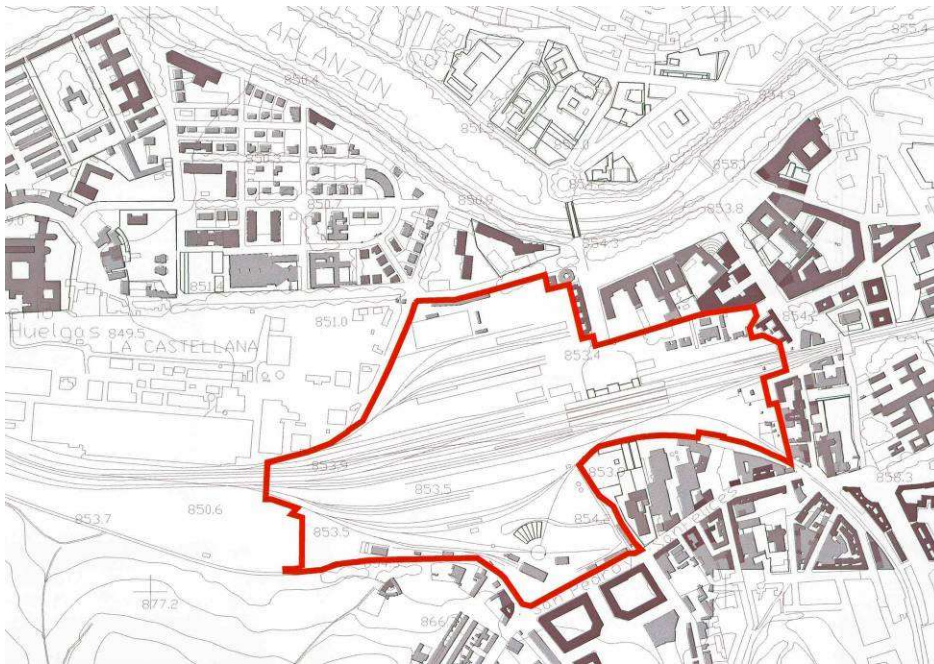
Plano de emplazamiento del ámbito del Plan Especial de Reforma Interior de la Estación de Renfe en Burgos, Texto Refundido de 2003. Plano A-01. Recinto de 280.745 m² (Fuente: Ayuntamiento de Burgos).
